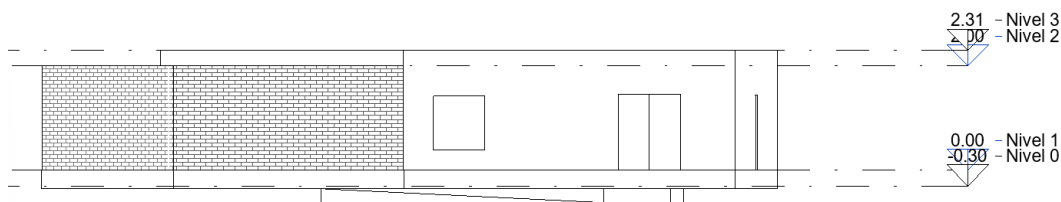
Alzado Sur modelo levantamiento con Cámara 360°. Fuente: elaboración propia.
